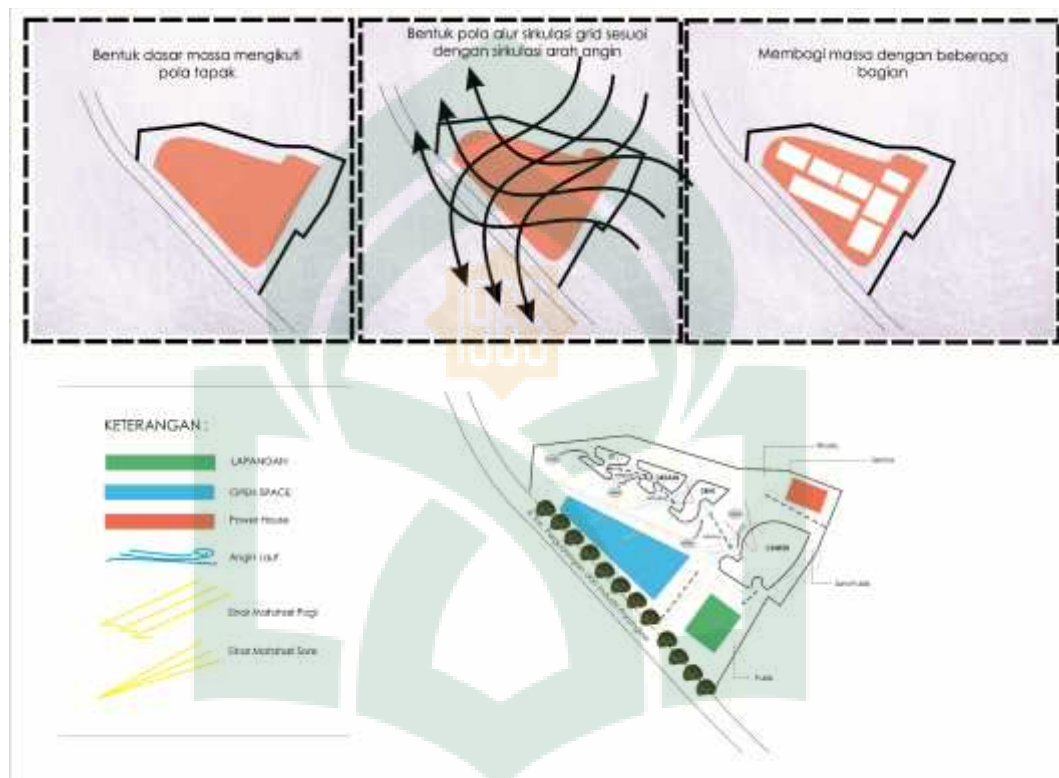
Alternatif 1 Bentuk Bangunan
